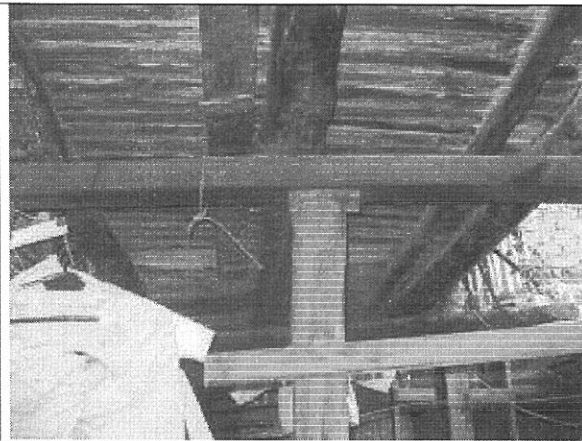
Elementos de madera que sostienen la construcción en mal estado
